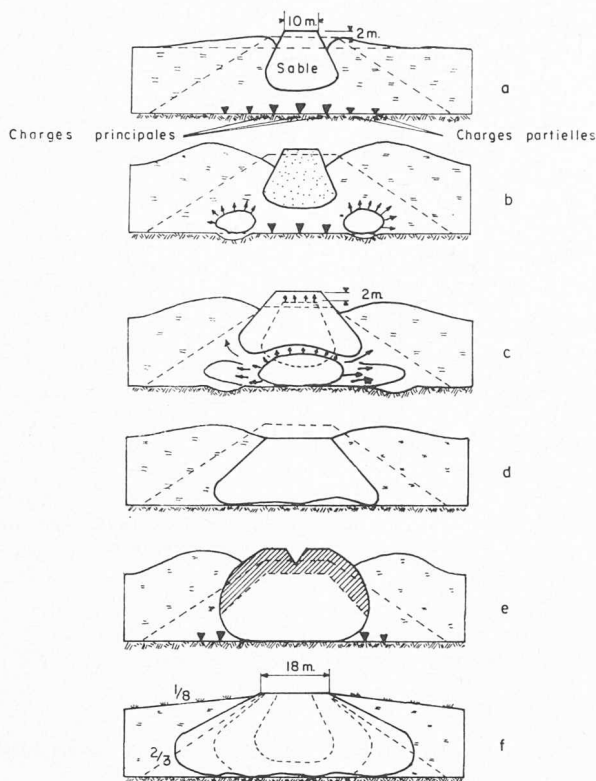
Procédé allemand d'explosion sous le remblai.
